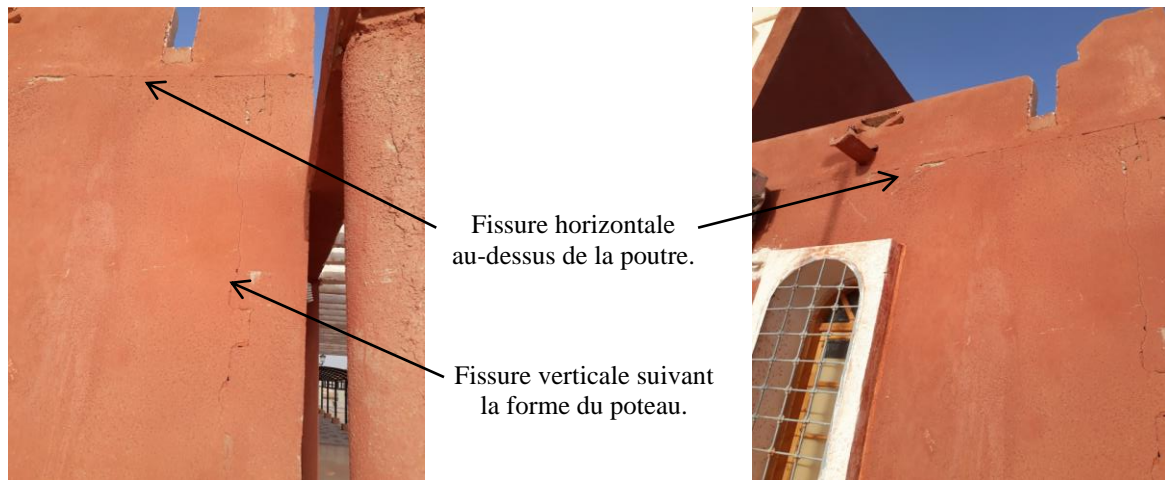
Fissure dans le poteau (Bloc administratif). Photo 2.16. Fissure lézard horizontale
